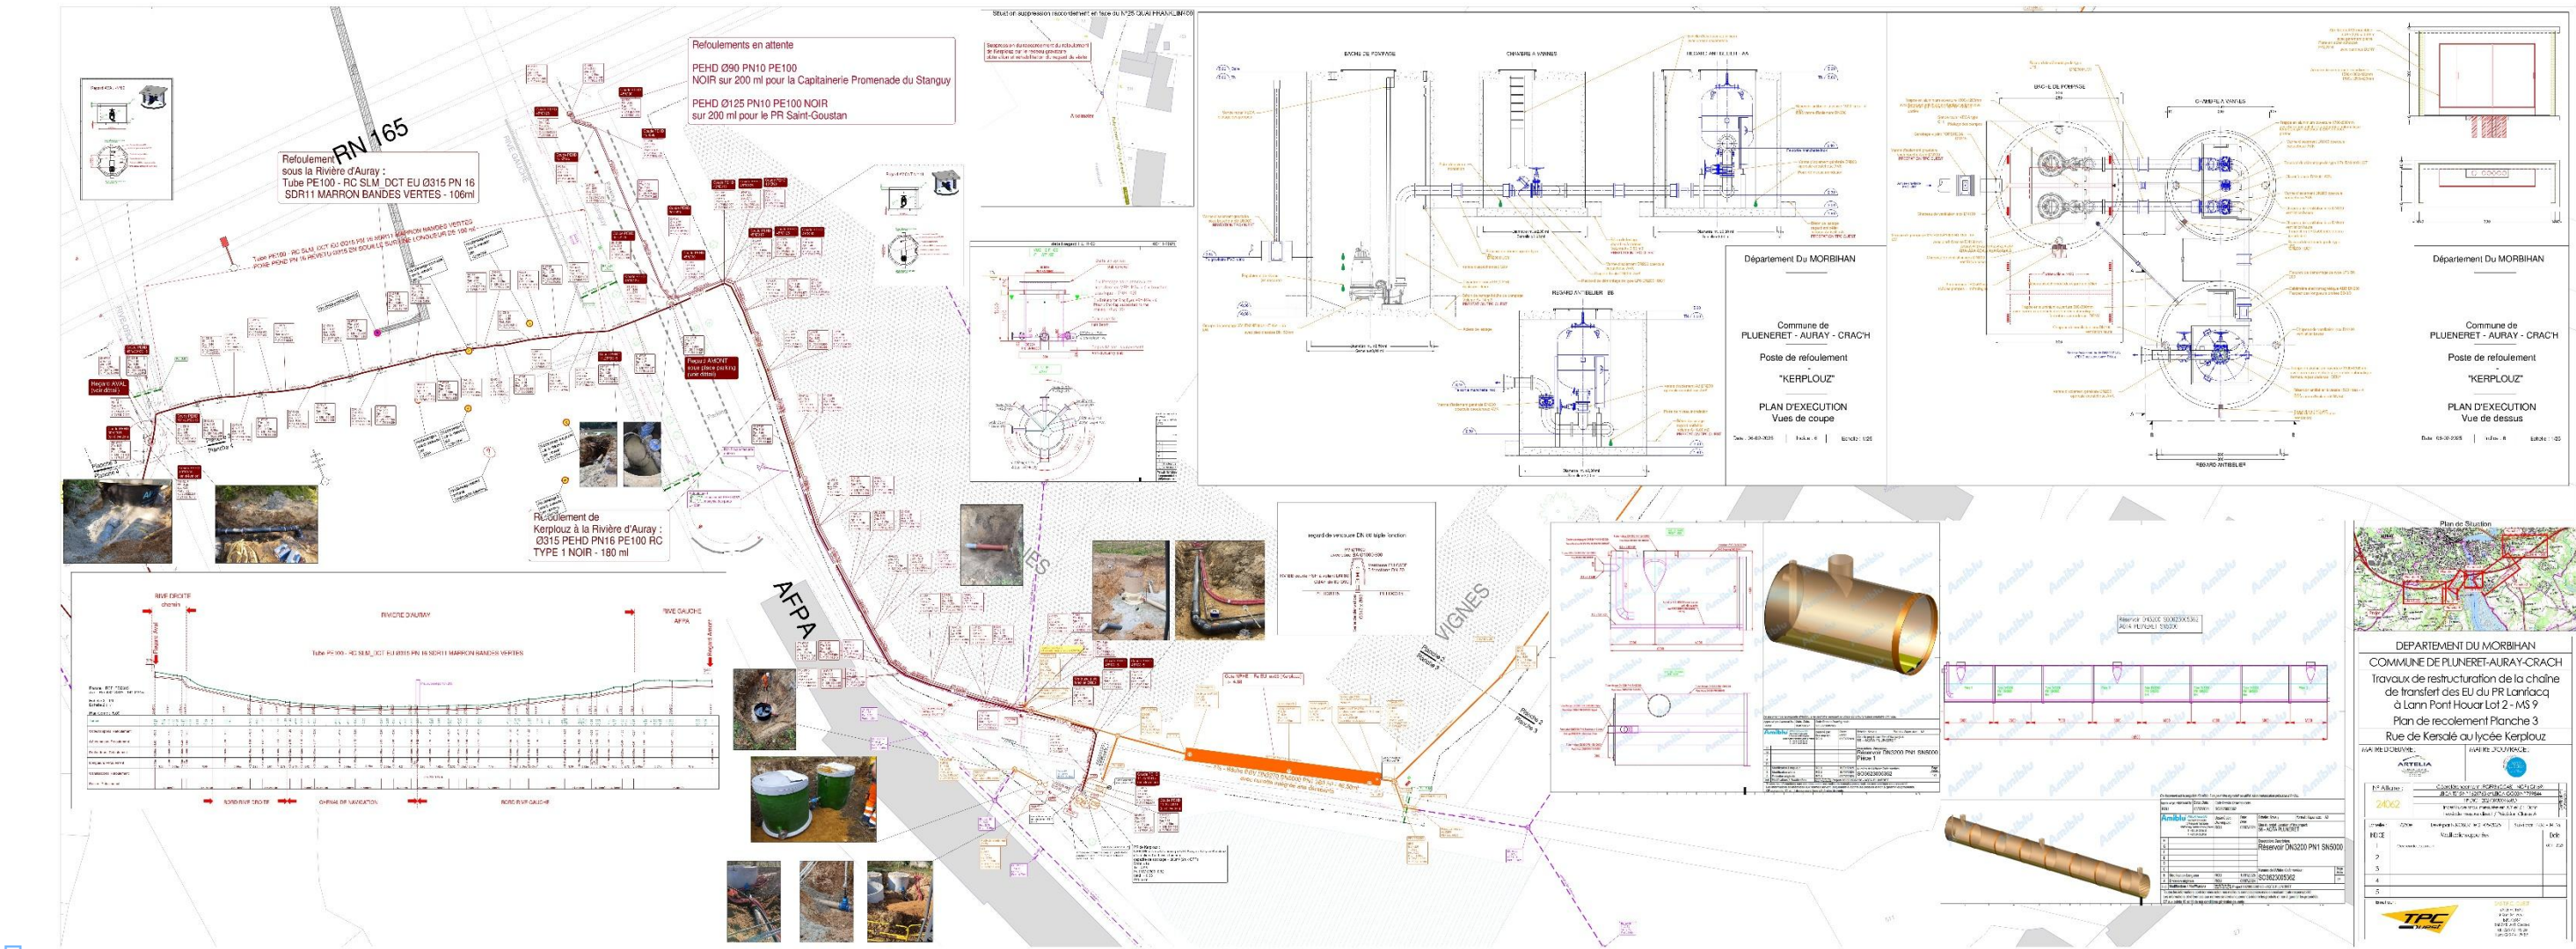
Plan de recollement de la traversée de la canalisation dans la rivière d'Auray
